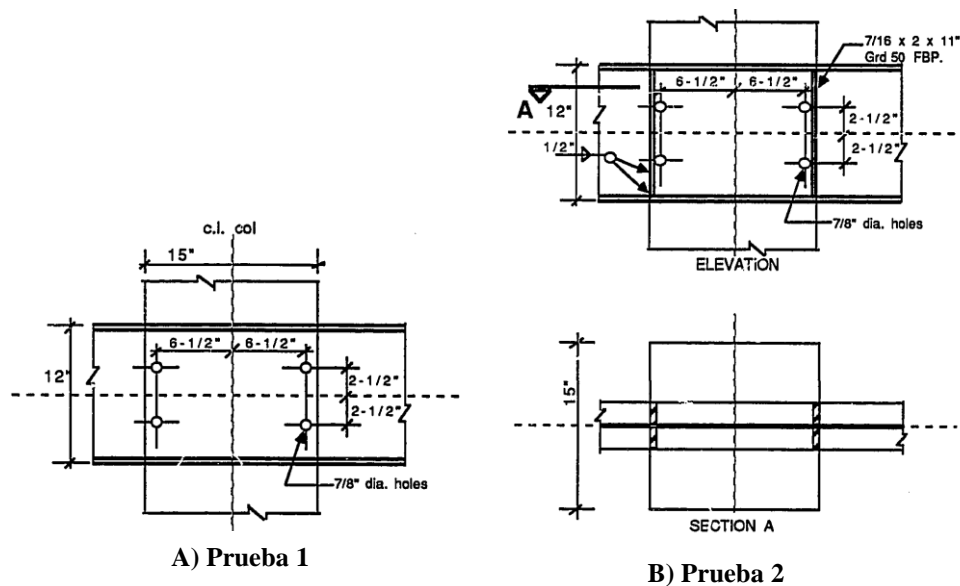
Detalles de las vigas en el área de la junta para las muestras 1 y 2. Nota. Shikh muhammad t. moment connections between steel beams and concrete columns (1987) (pág.44)
